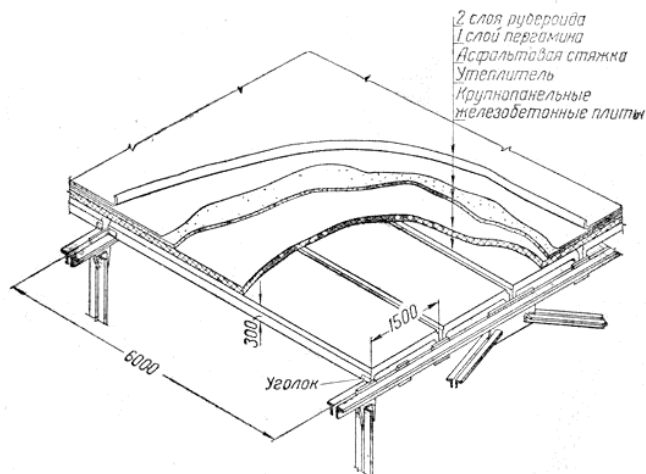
Беспрогонное покрытие ледового катка с теплой кровлей
